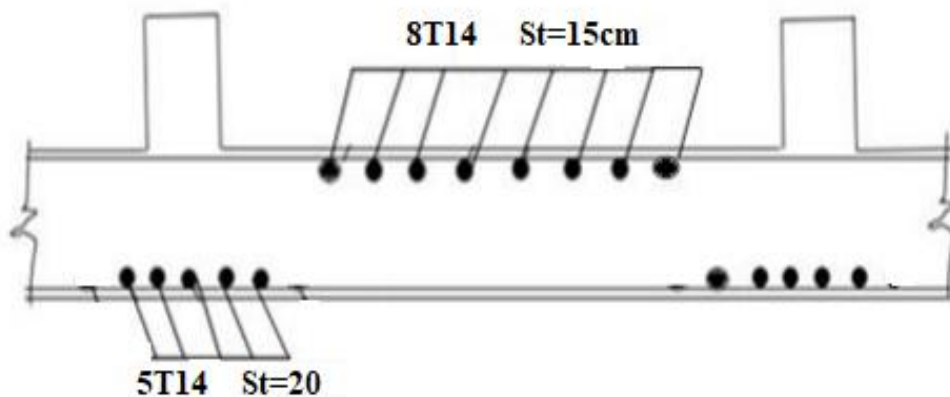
Schéma de ferrailage de la dalle du radier (sens xx).
